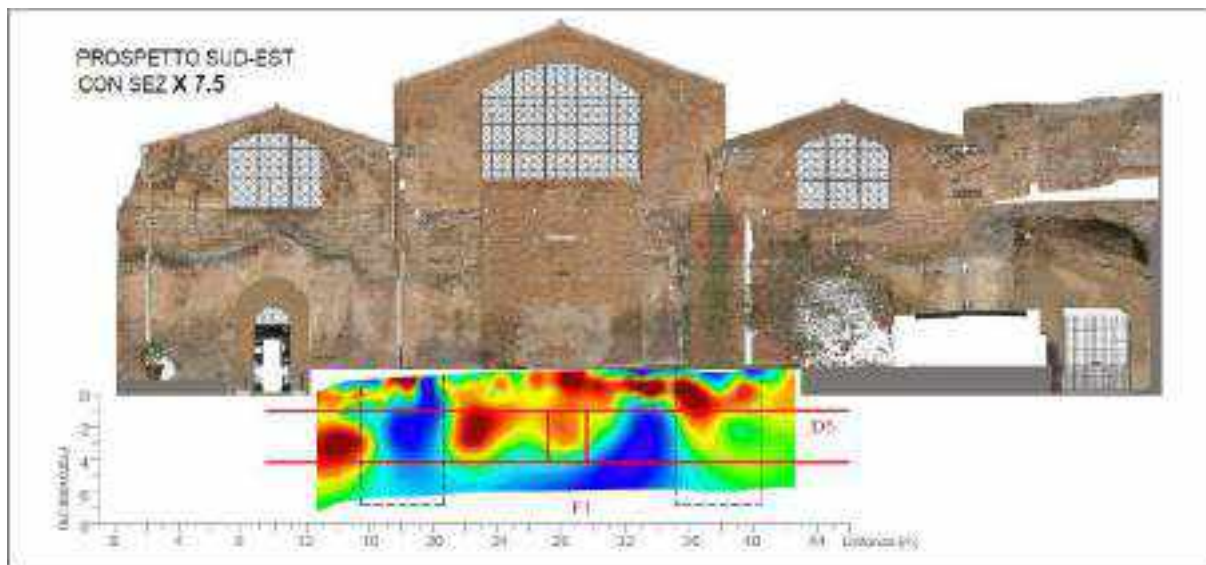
Prospetto Sud-Est con sezione $x = 7,5$ m del volume ERT 3D.
